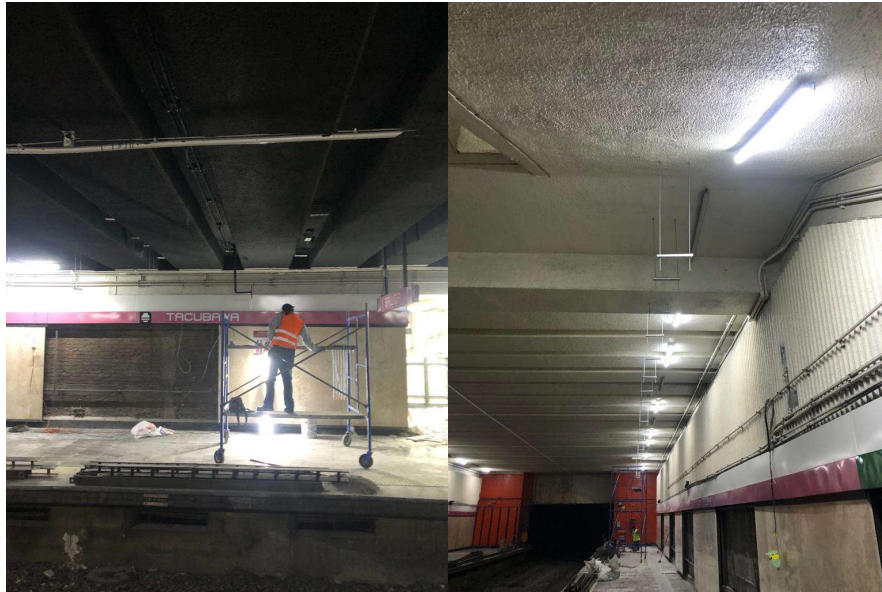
Instalación de soportería para charola de malla. Elaborado por el autor.
